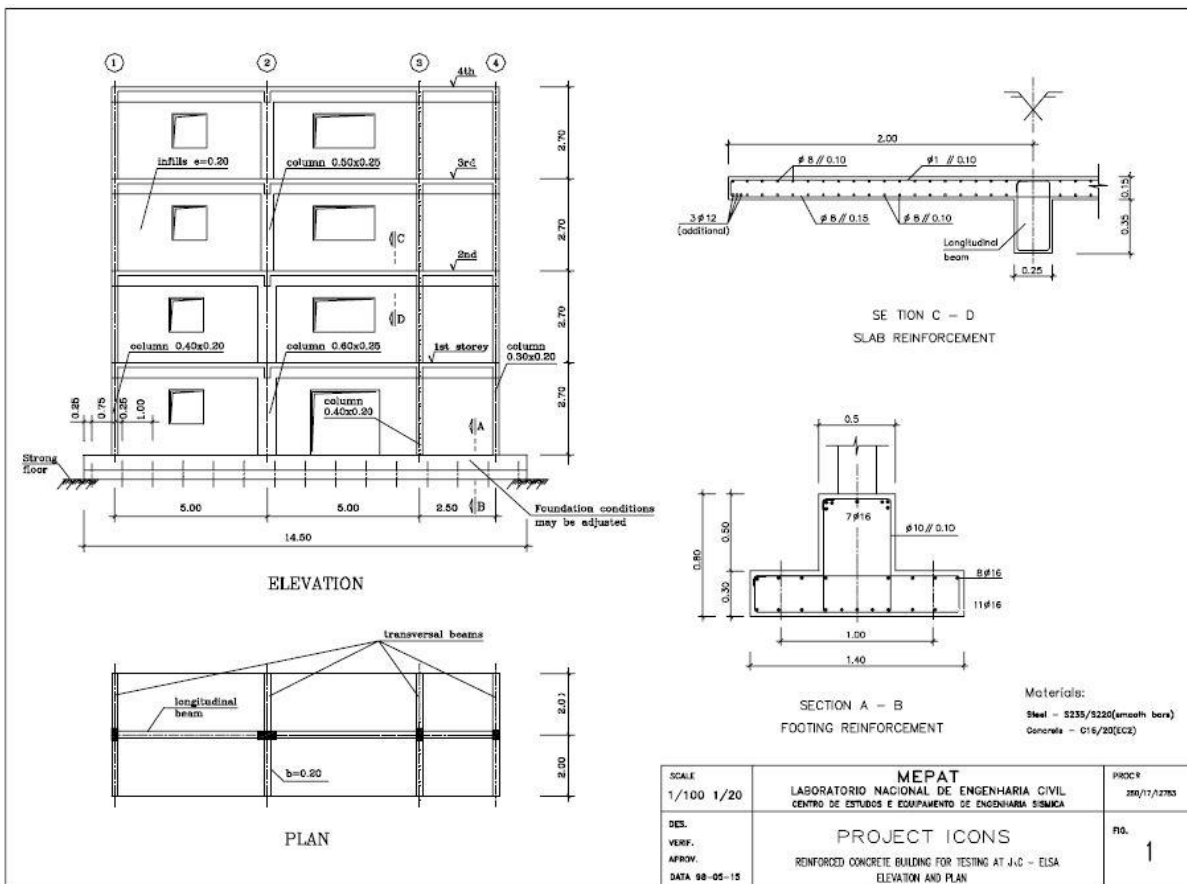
Vista em planta e alçado do pórtico estudado, [29]
